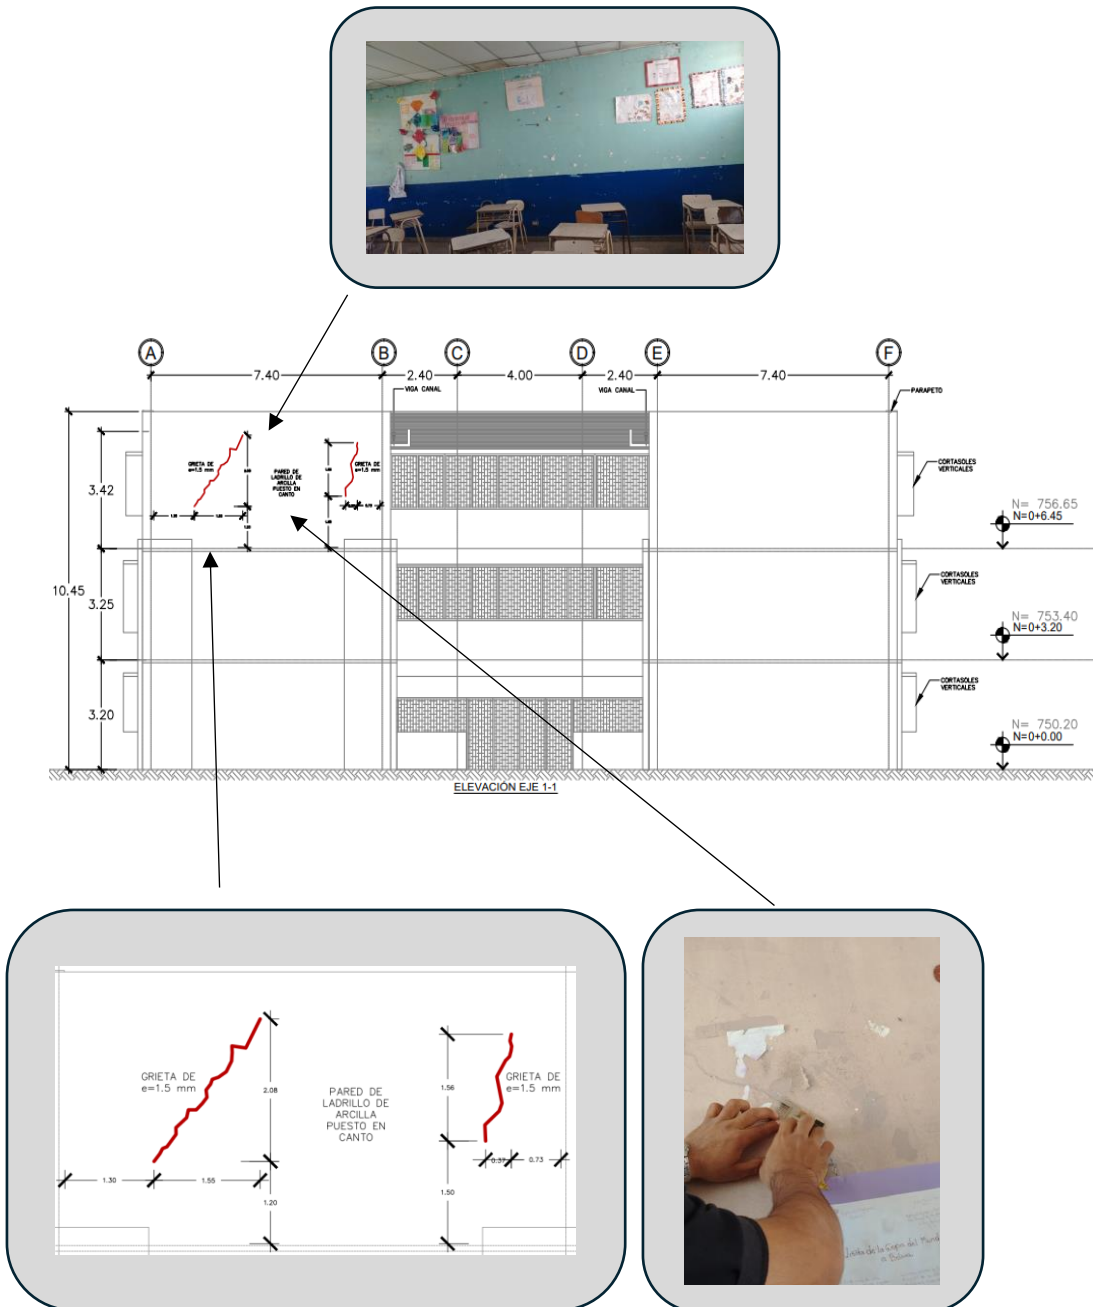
Esquema de daños en pared de mampostería de ladrillo de barro, tercer nivel, eje 1-1, tramo A-B.
